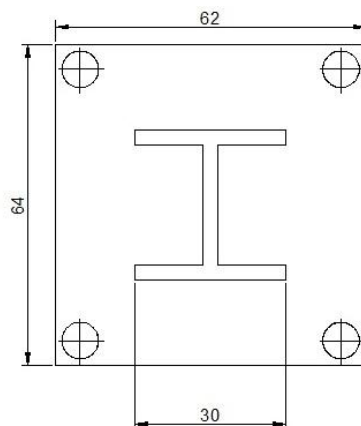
78. Dimensiones a comprobar de la placa de anclaje.
